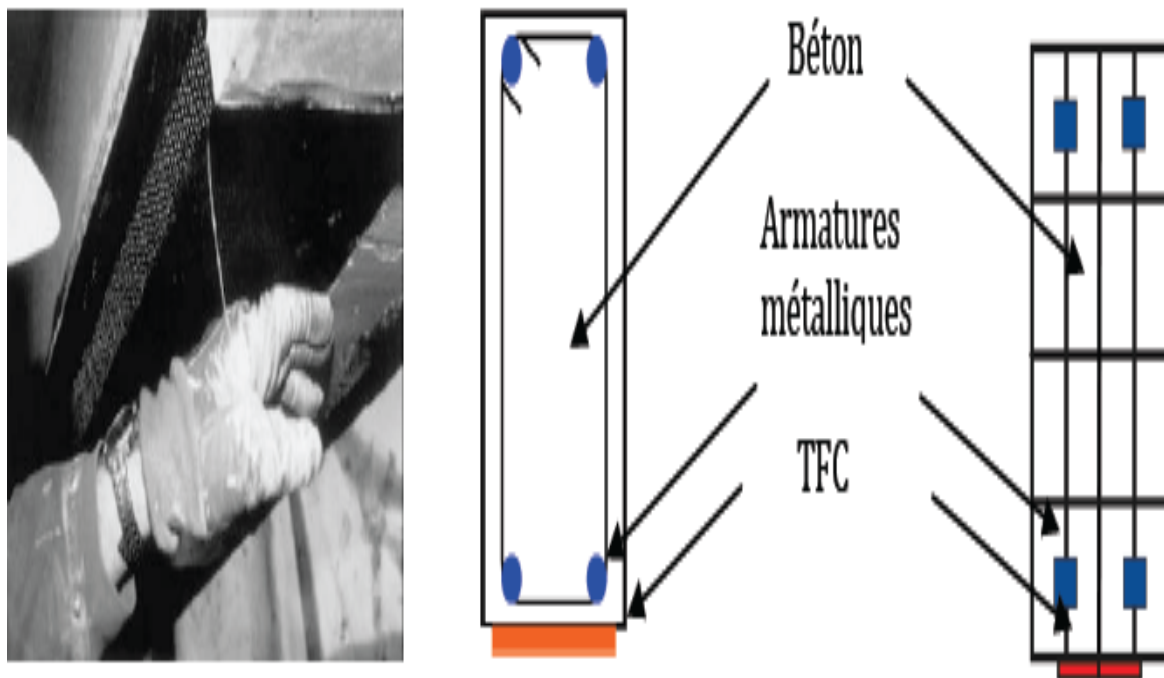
Poutre renforcée par collage de (TFC) (représentation multifibres) [4]
